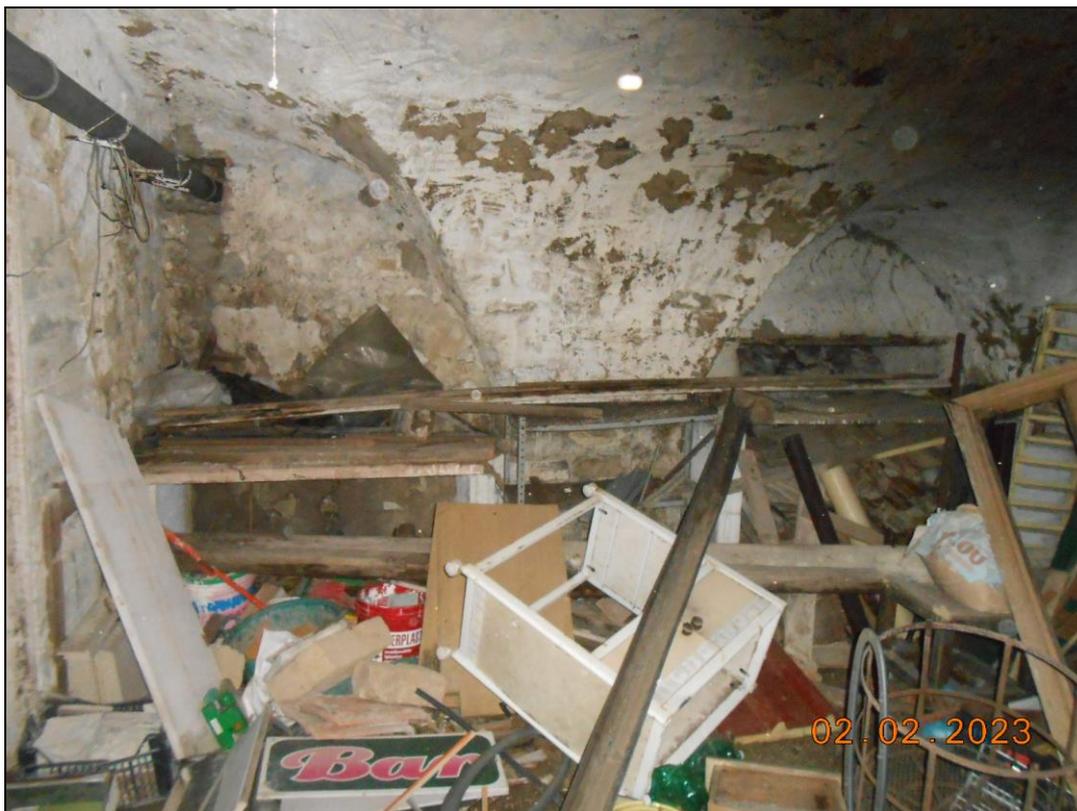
Vista interna del piano interrato dell'immobile pignorato. Si notano rifiuti di ogni genere.
